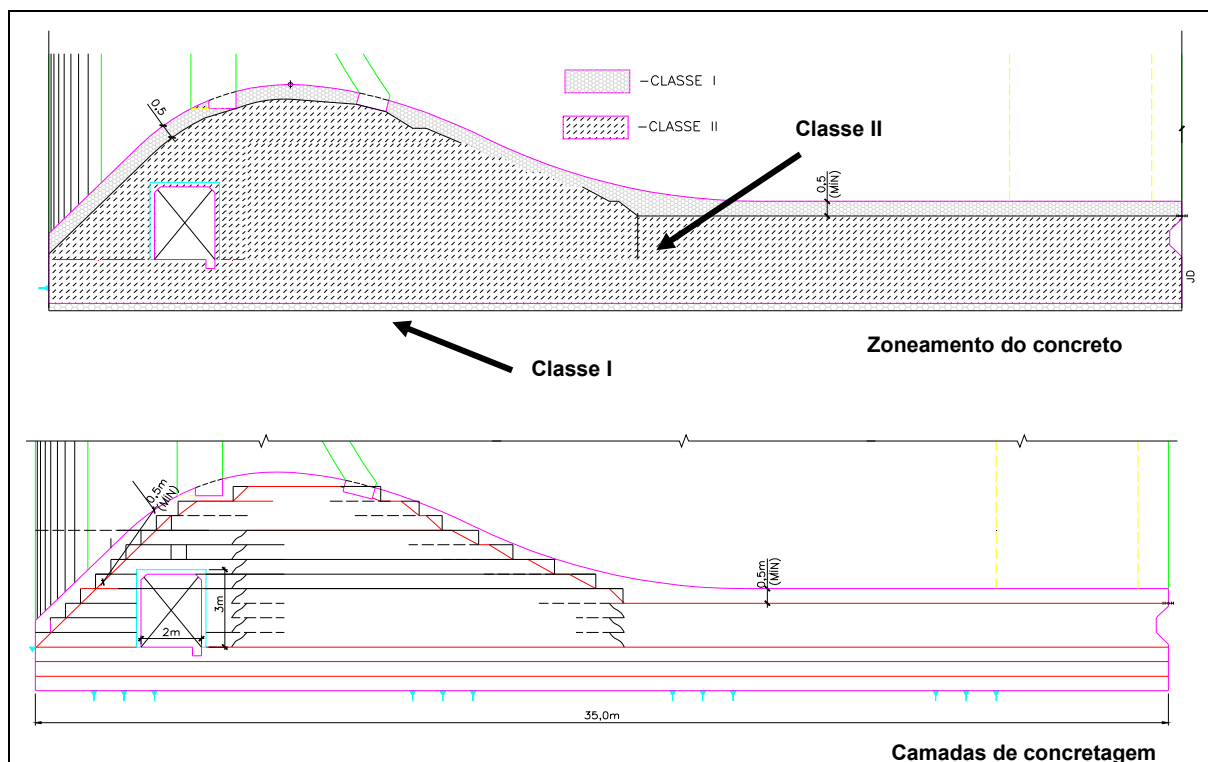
Zoneamento e camadas de concretagem do vertedouro – Seção transversal
